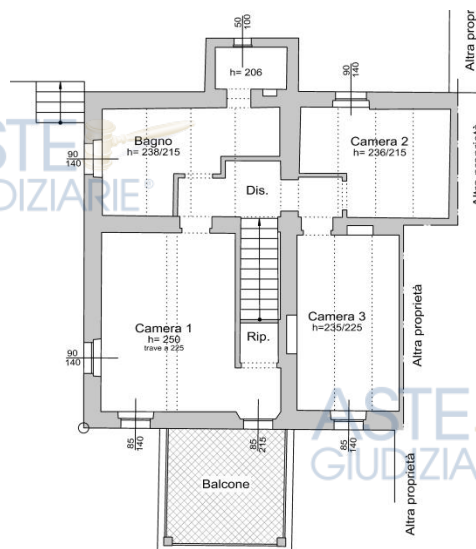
Rilievo piano primo eseguito dalla CTU- estratto di Allegato A) Elaborati grafici
